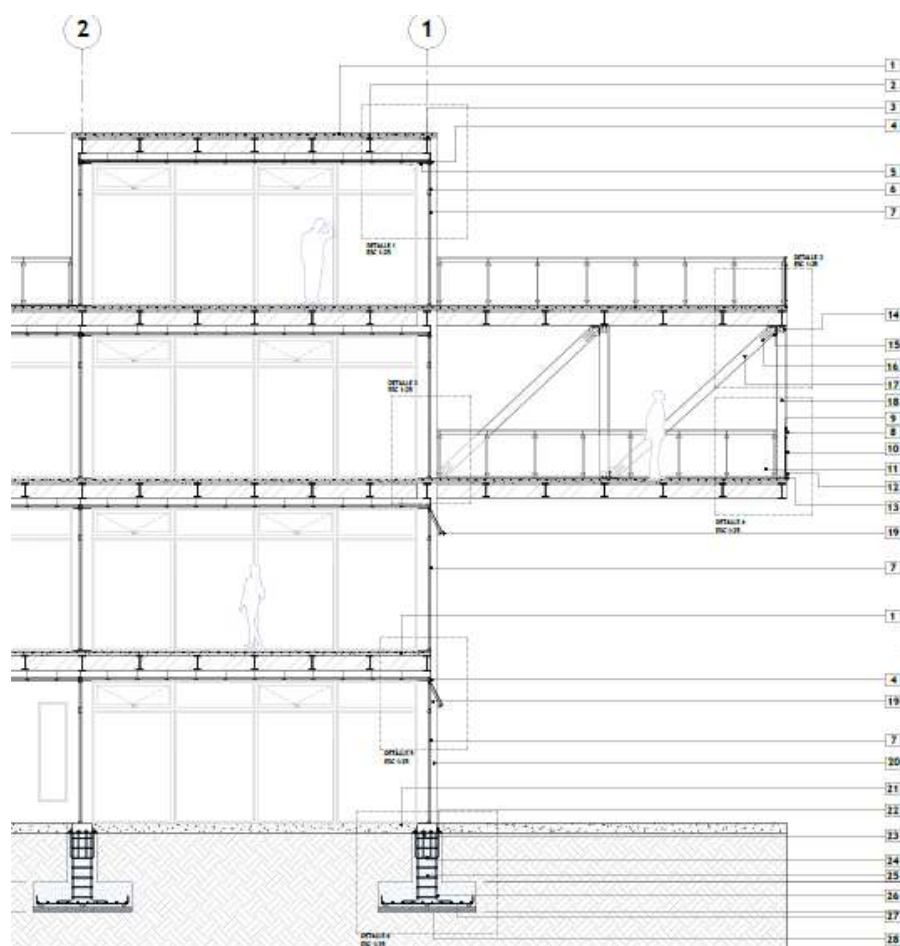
Corte por muro de una parte del proyecto en donde se muestra la relación de materialidad, estructura
